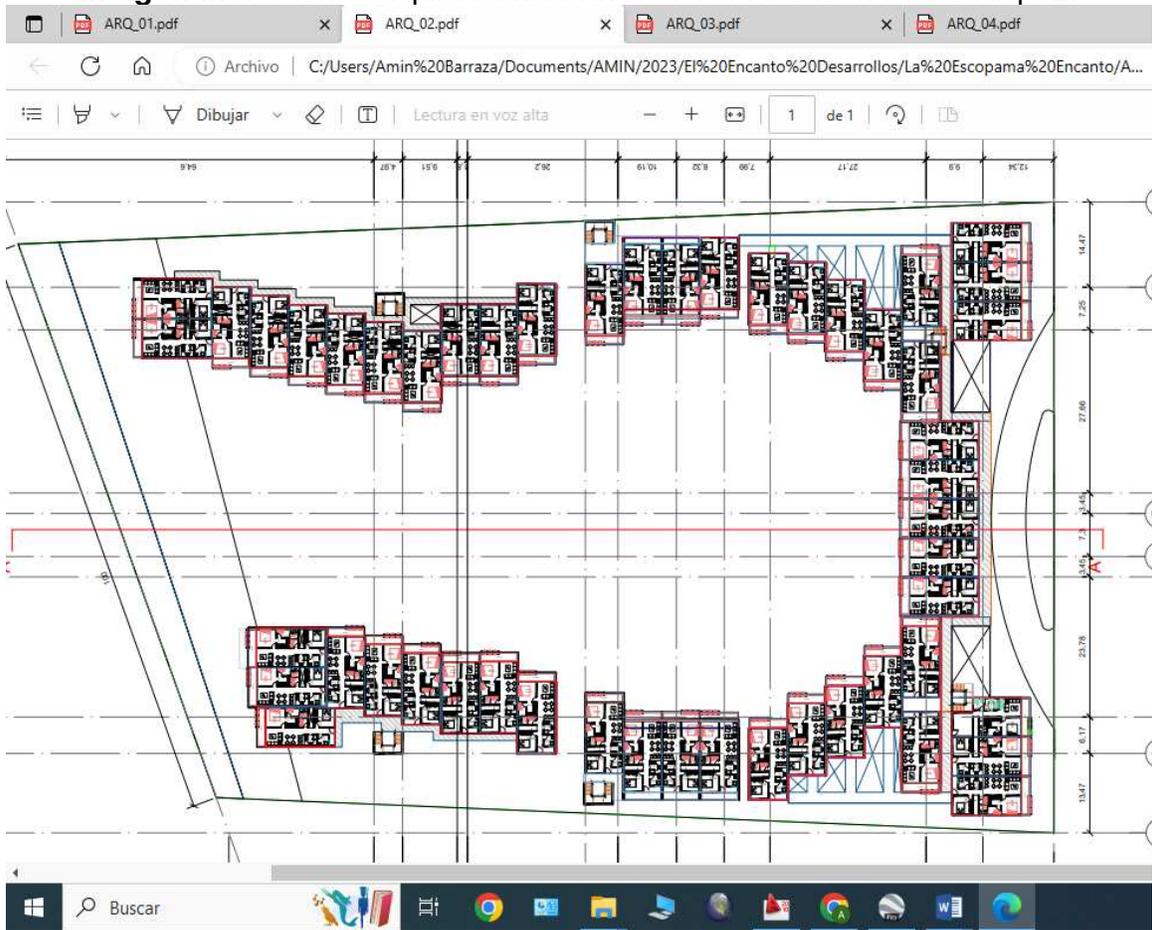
Planta arquitectónica nivel 3 y 4. Ver Anexo 4. Plano Arq-03.
